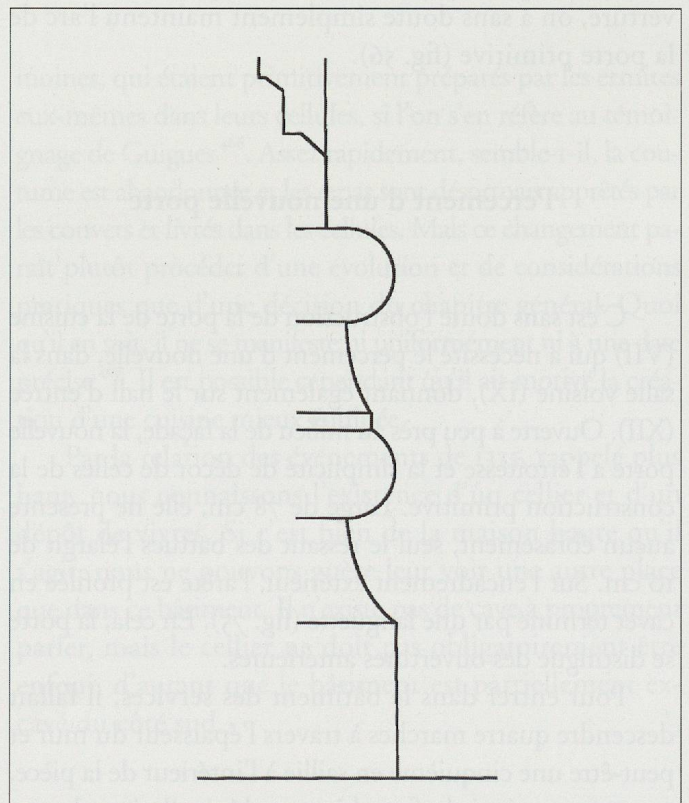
Profil du piédroit de la cheminée de la salle IX. Échelle 1 : 4
